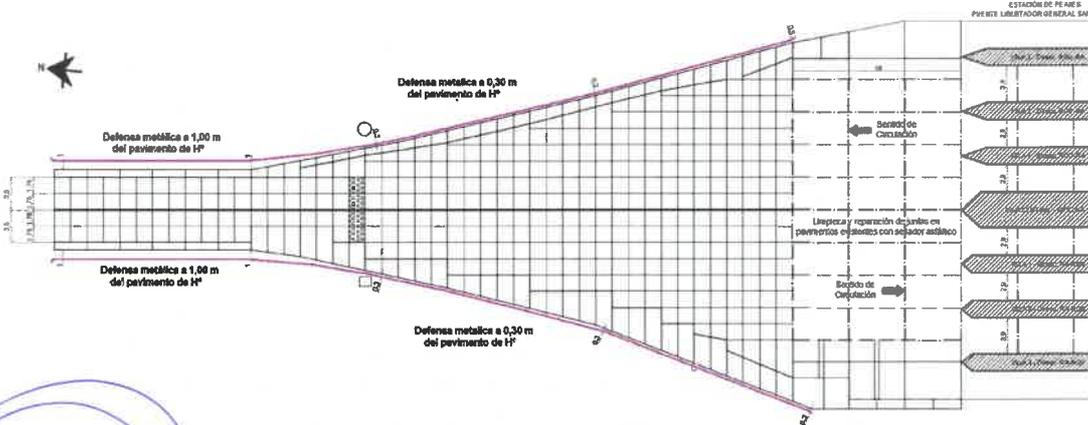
Detalles del desarrollo de las defensas metálicas a colocar.
